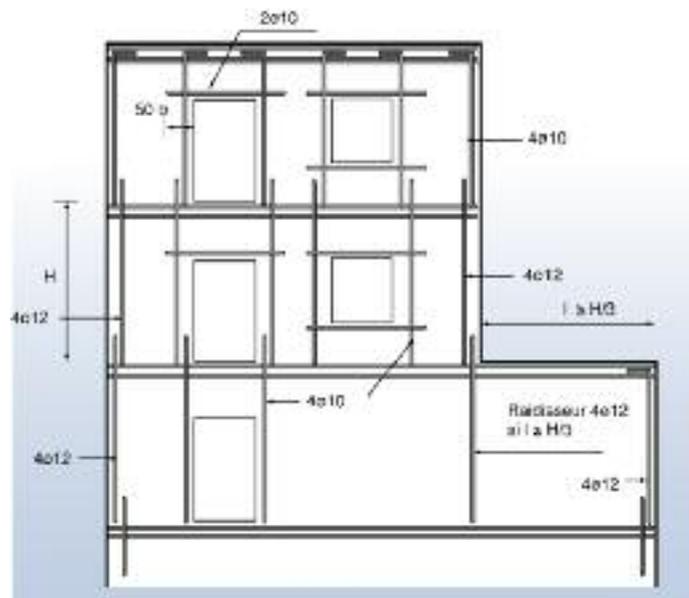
Voiles faiblement armés : chaînages et linteaux en élévation
